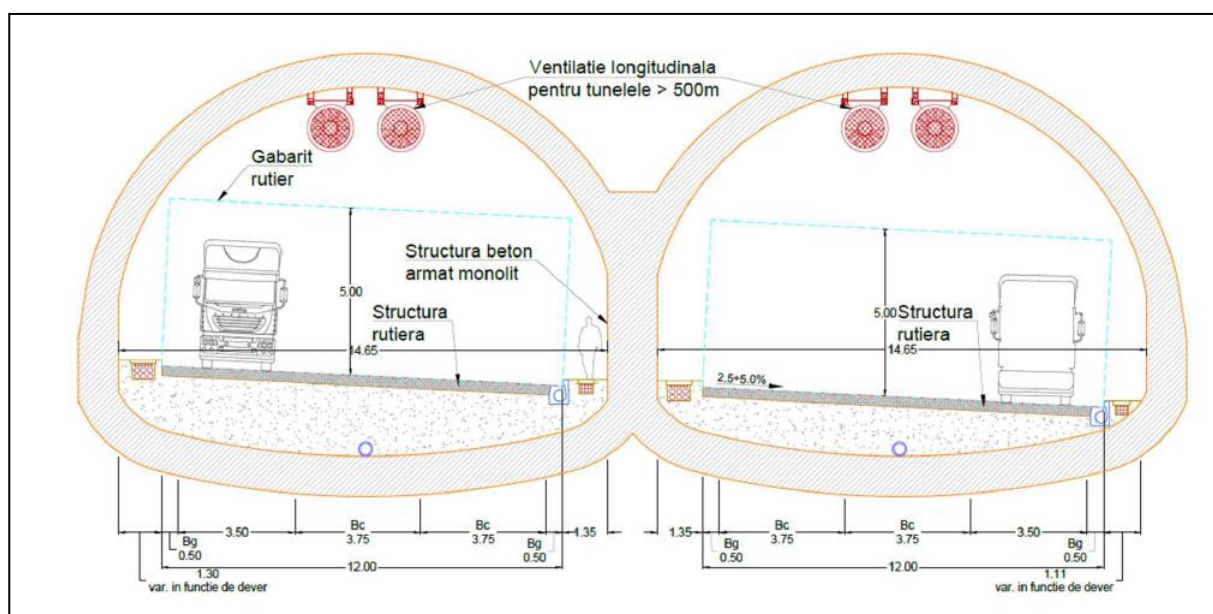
Secțiune transversală Tunel Artificial tip boltă – 3 benzi/sens (PTT01)
